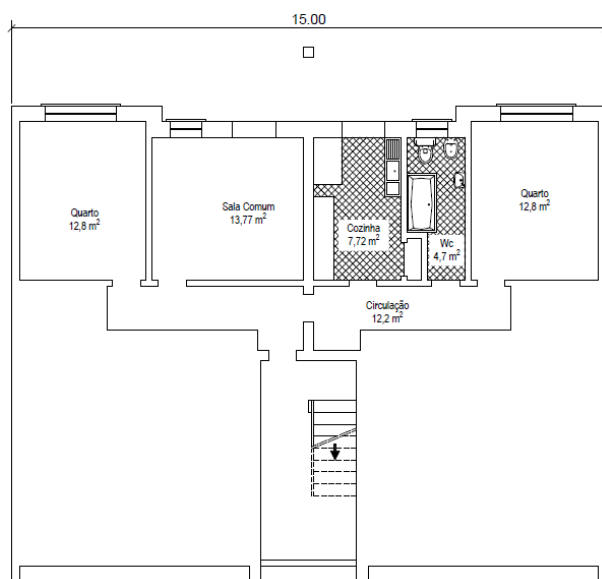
Planta de arquitetura do piso semi-enterrado
